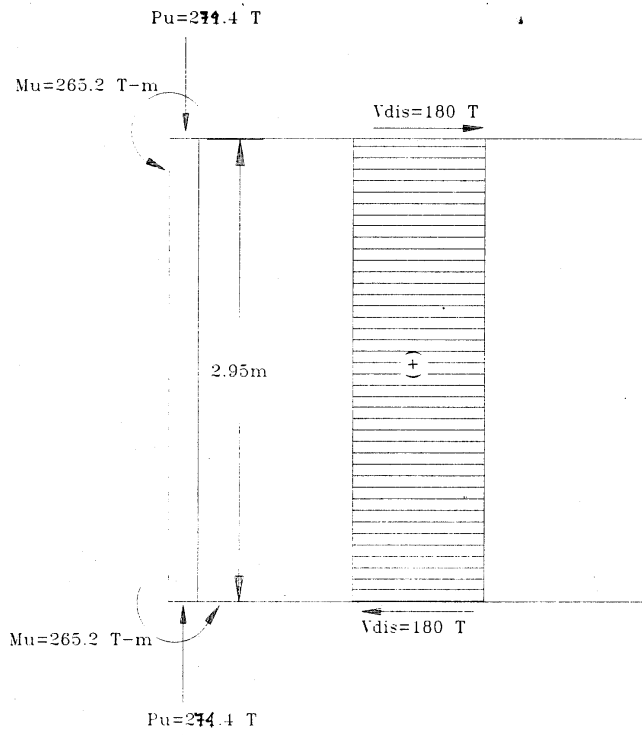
Diagrama de cortante de diseño para cálculo de estribos en columna.
